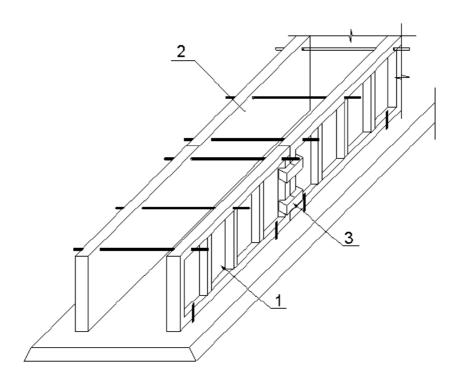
Раскрепление щитов опалубки арматурными стержнями:
